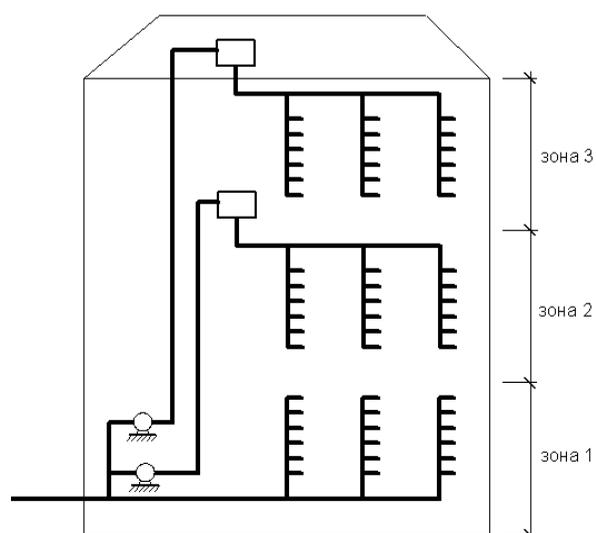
Схема водоснабжения здания с местной насосной установкой и гидропневматическим баком на чердаке
